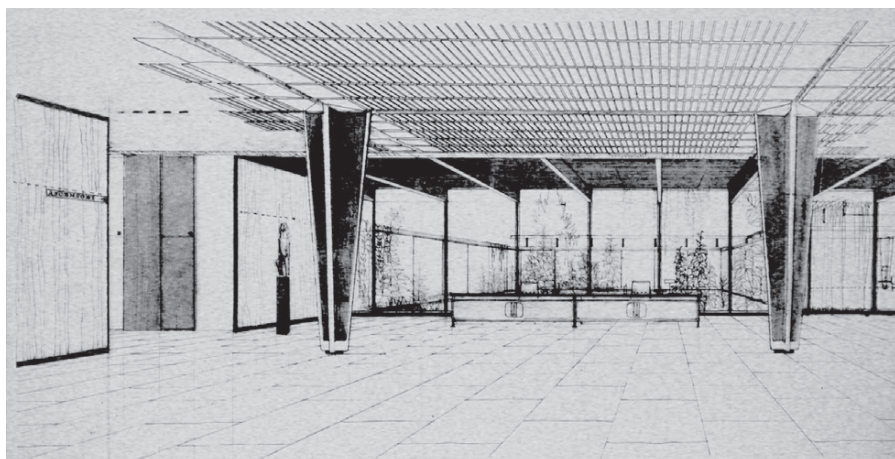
Disegno prospettico dell'ingresso (AB)
